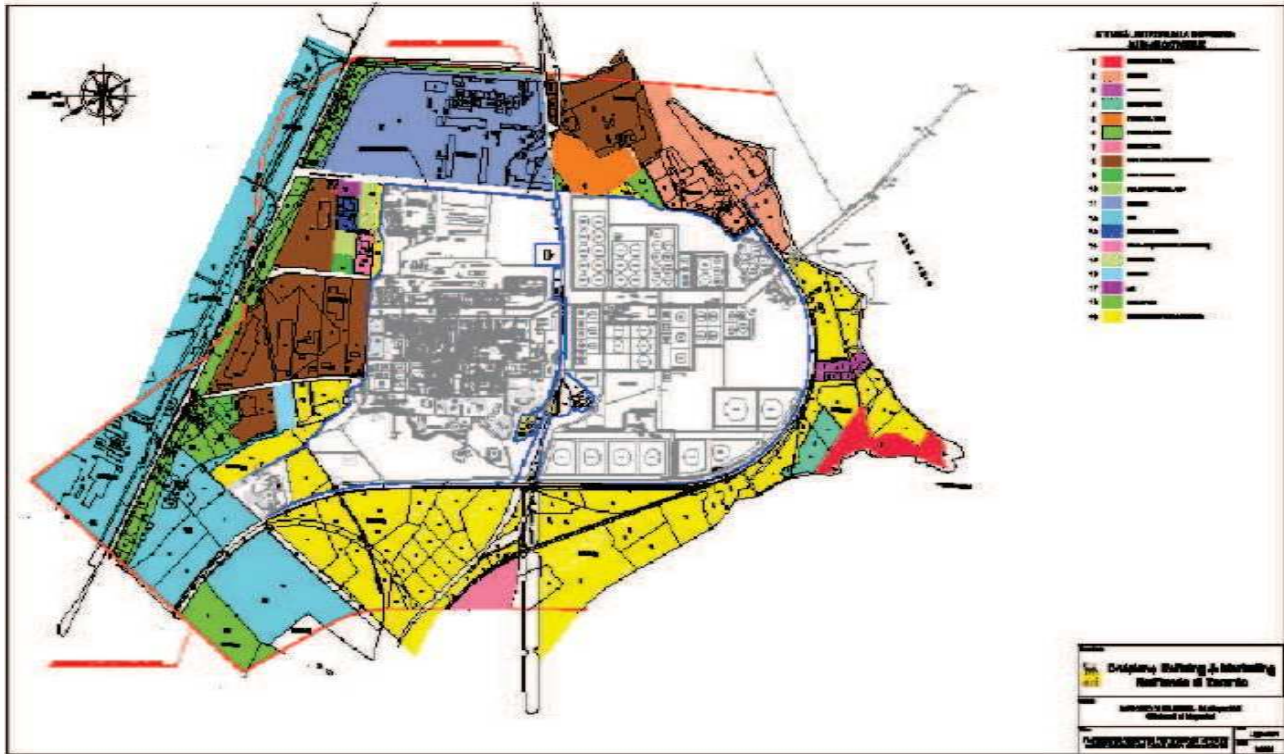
Area Tempa Rossa onshore – planimetria generale
